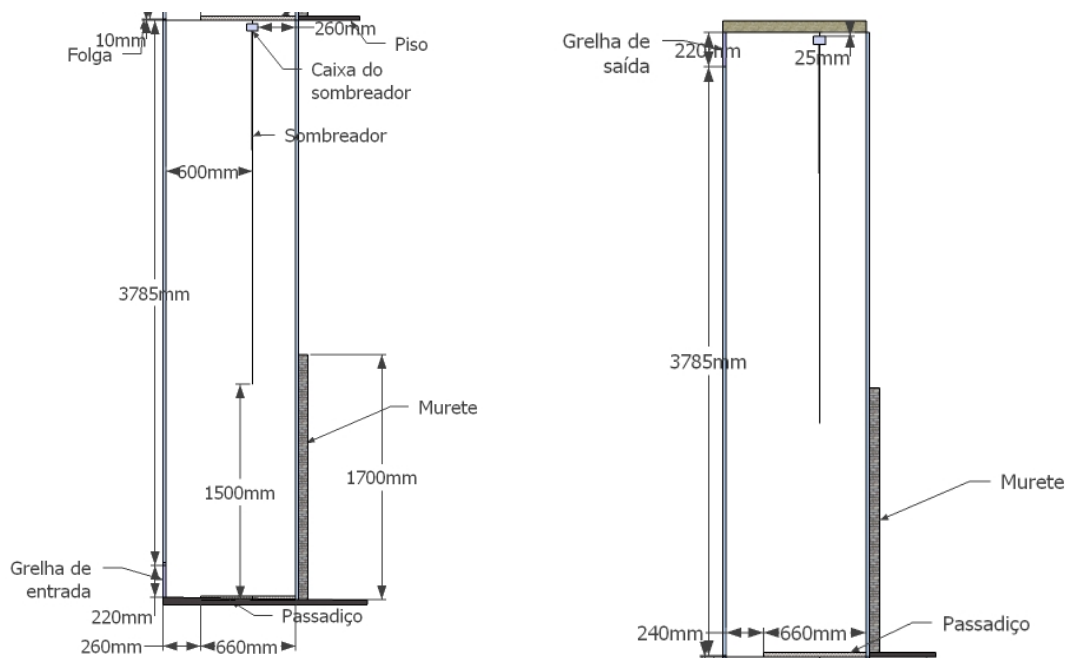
Ilustração pormenorizada do perfil da fachada (Esquerda – piso inferior; Direita – piso superior).
